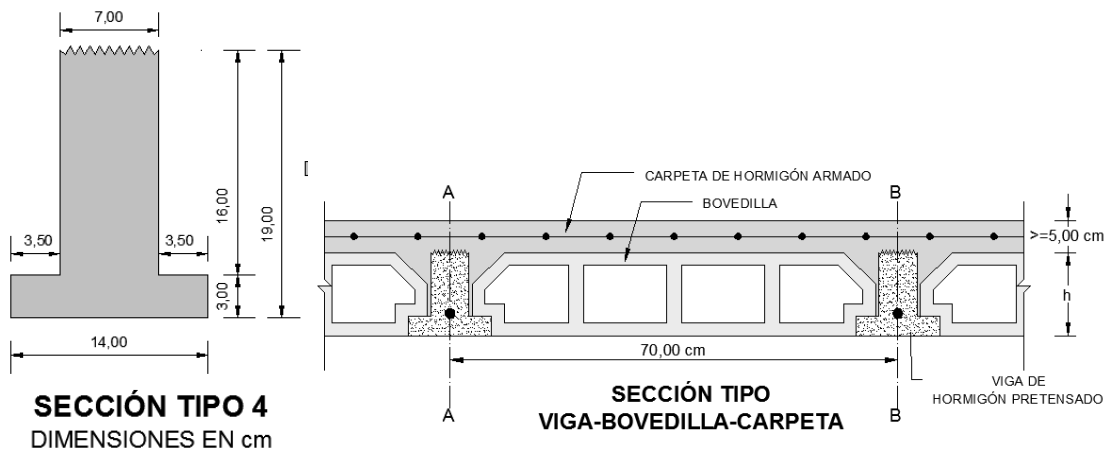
Sección Transversal inicial Viga de L=6,00 m.
